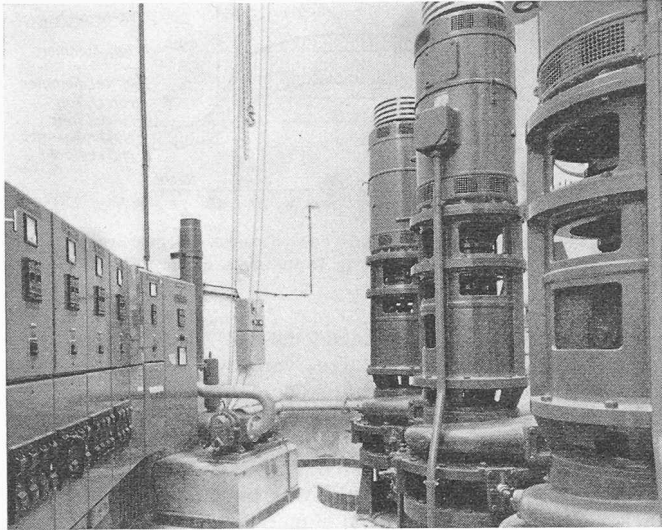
Inneres einer Pumpstation mit vertikalachsigen Abwasserpumpen
